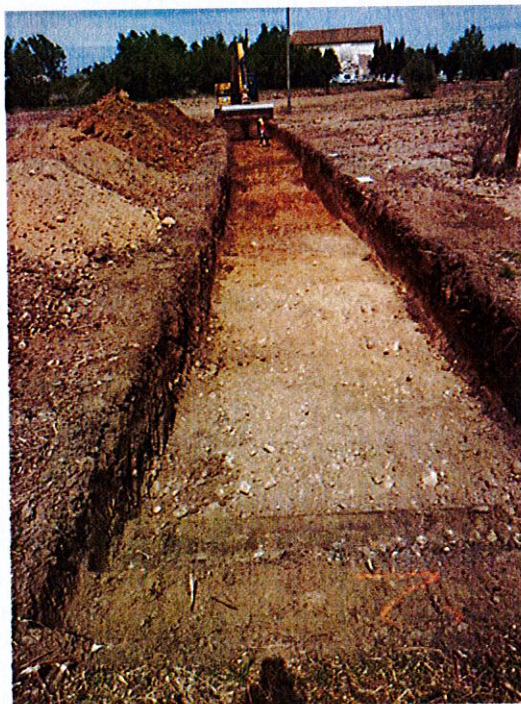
Au premier plan la terrasse alluviale pléistocène et au second plan, les marnes tertiaires. Auteur : Gwénaél Herviaux).
